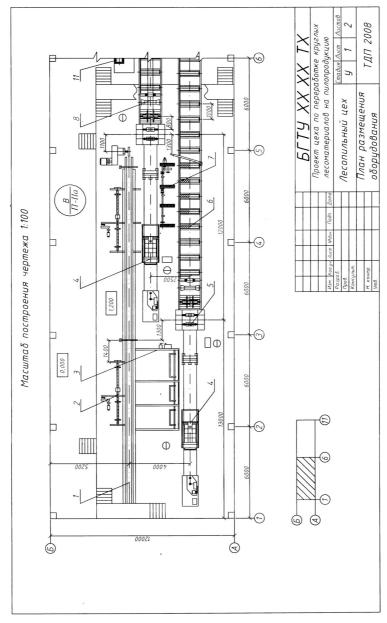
а. Схема одноэтажного лесопильного цеха (участок лесопильных рам)
